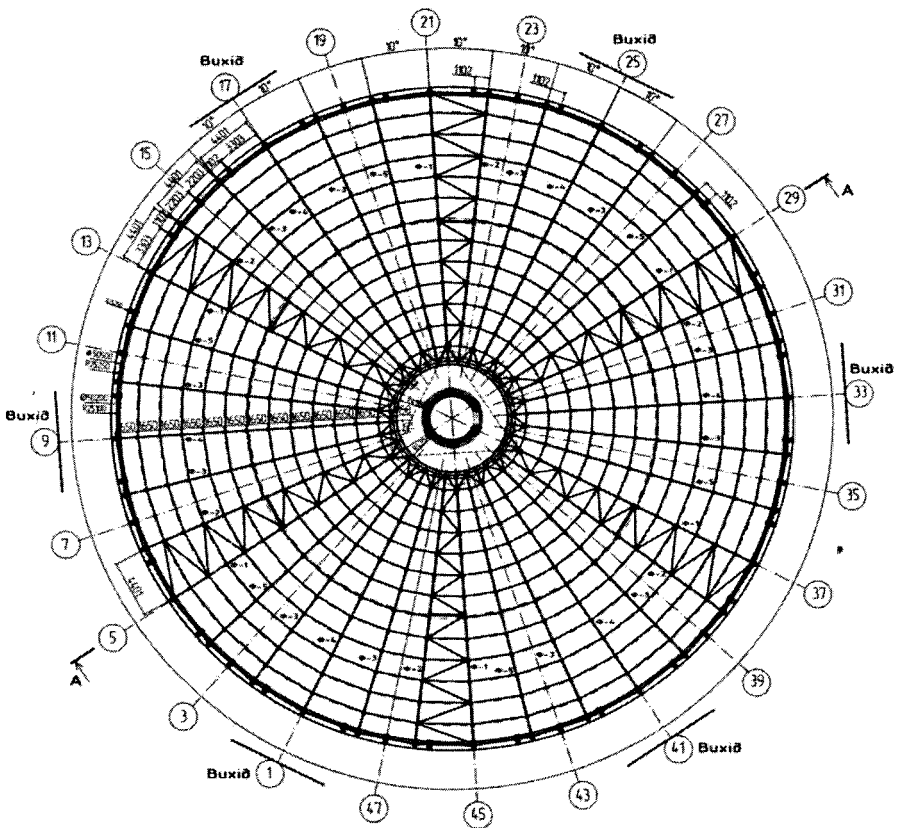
План покриття будівлі з монтажною схемою розташування радіальних ферм, прогонів, вертикальних зв'язків і розпірок між поясами ферм та зв'язків по верхніх поясах ферм. Переріз "А – А" наведений на рис. 5.81
